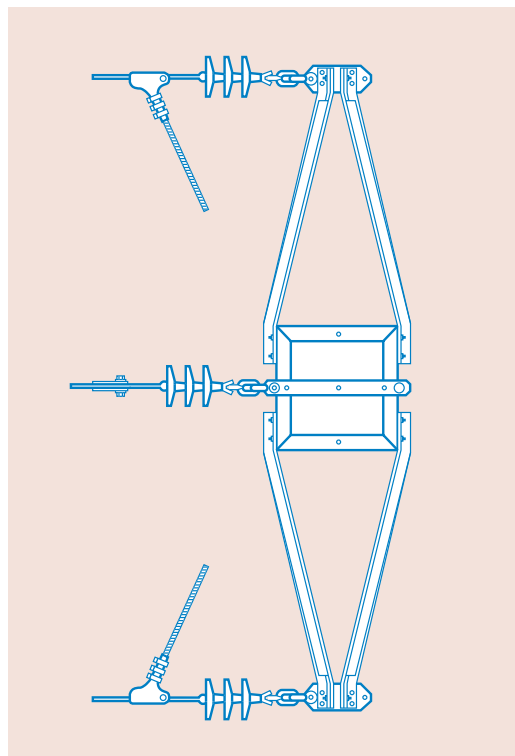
Vista en planta d'un suport metàl·lic amb les cadenes d'aïllament
